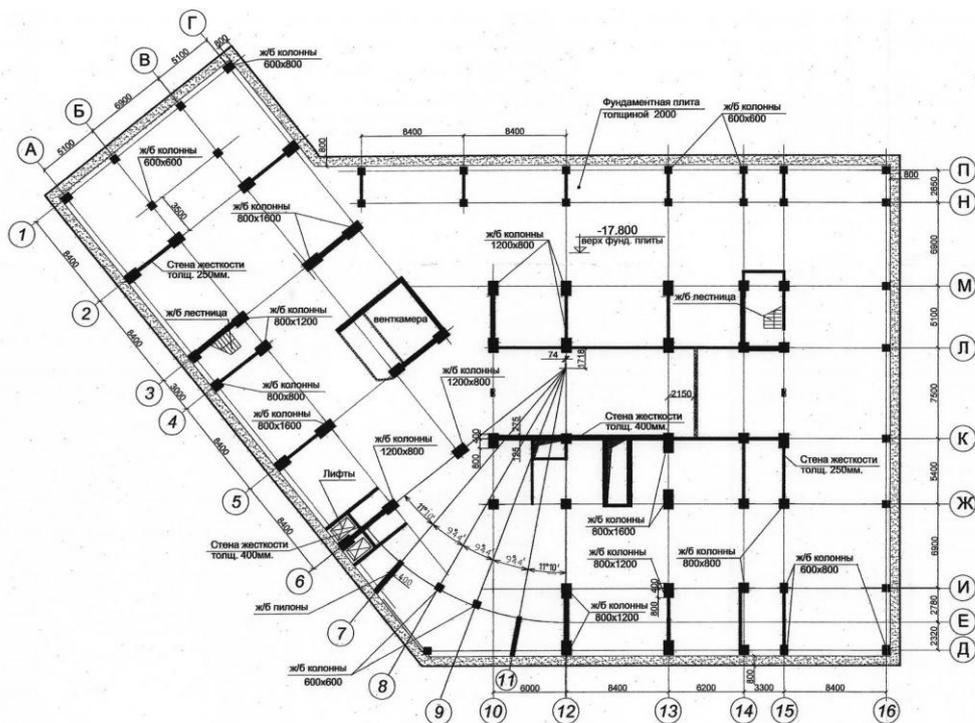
План конструкций минус пятого этажа на отм. -17.800 (верх фундаментной плиты) высотного здания
